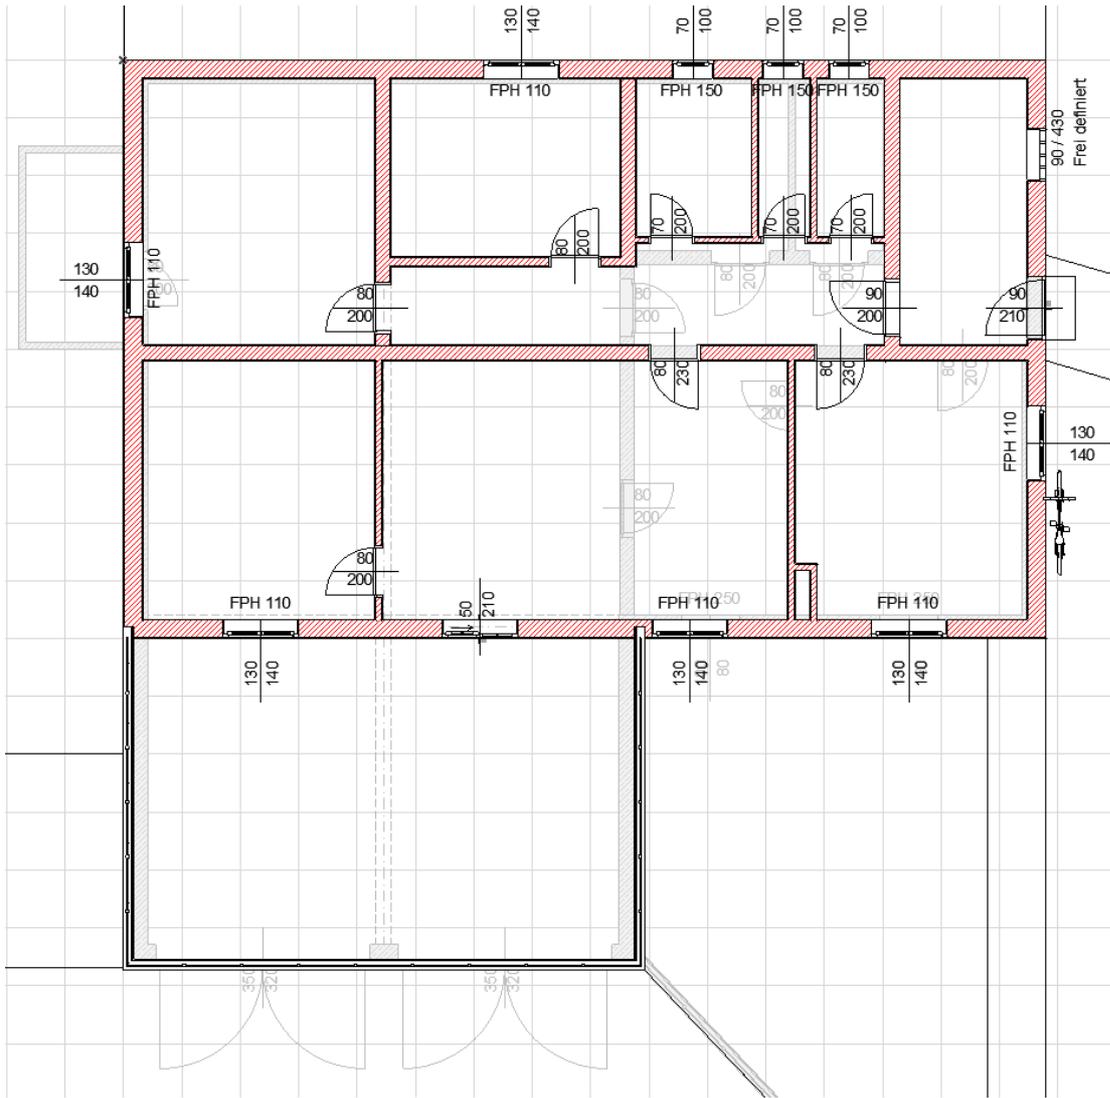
Grundriss Bestandsgebäude Erdgeschoss [50]
